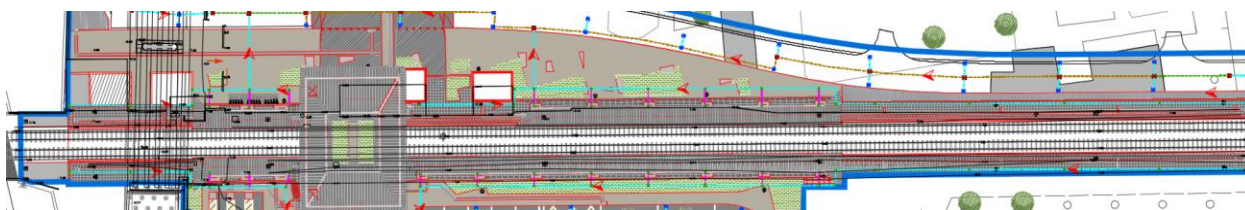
Schema di drenaggio viabilità di accesso al parcheggio
